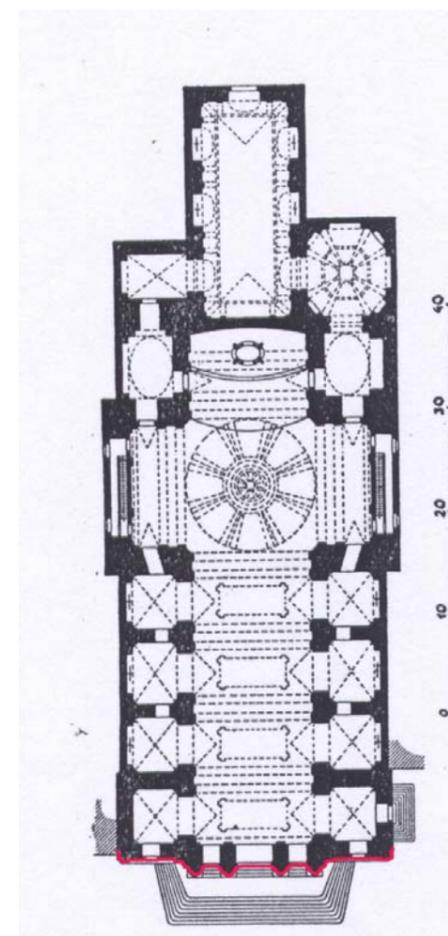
Pianta di San Juan Bautista di Toledo, 1622
